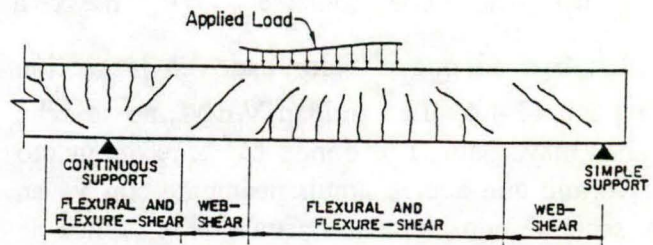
Tipos de agrietamiento en vigas de hormigón.
